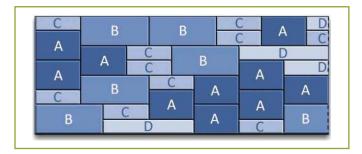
Calepinage de blocs muraux selon un plan de pose (Dessin de Cédric Houel)
